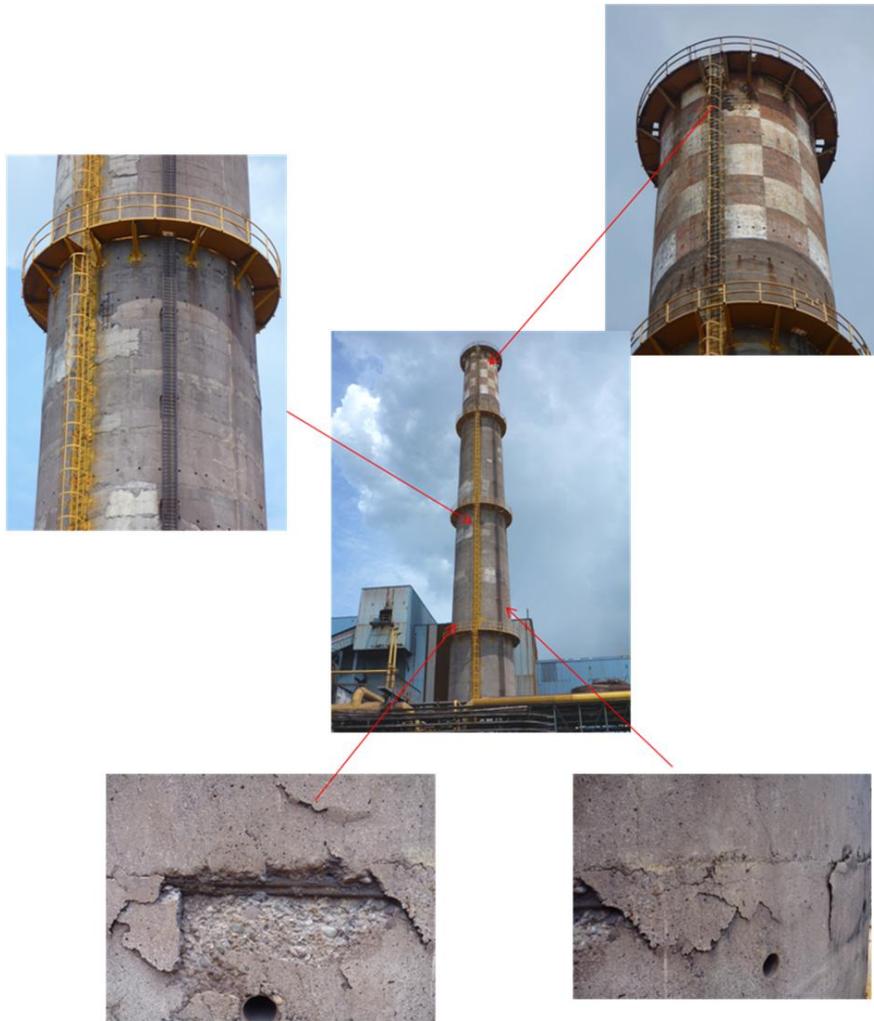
Deterioros en la Chimenea de la Planta Peletizadora
